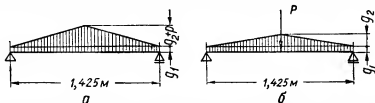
Расчетная схема поперечного ребра и схемы нагрузок при действии: а — постоянной и снеговой нагрузки. б — постоянной и сосредоточенной нагрузки.
